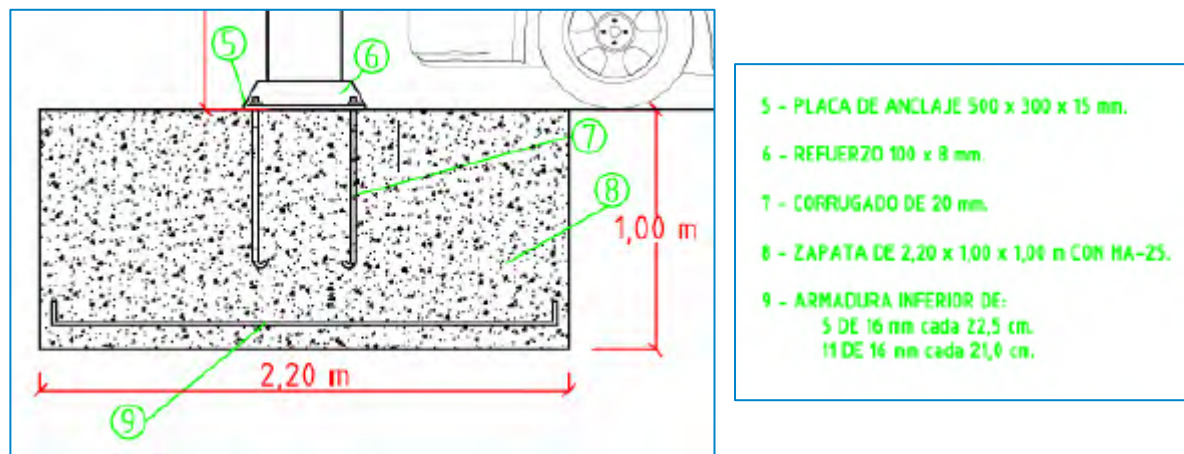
Zapata de cimentación para marquesina de aparcamiento
